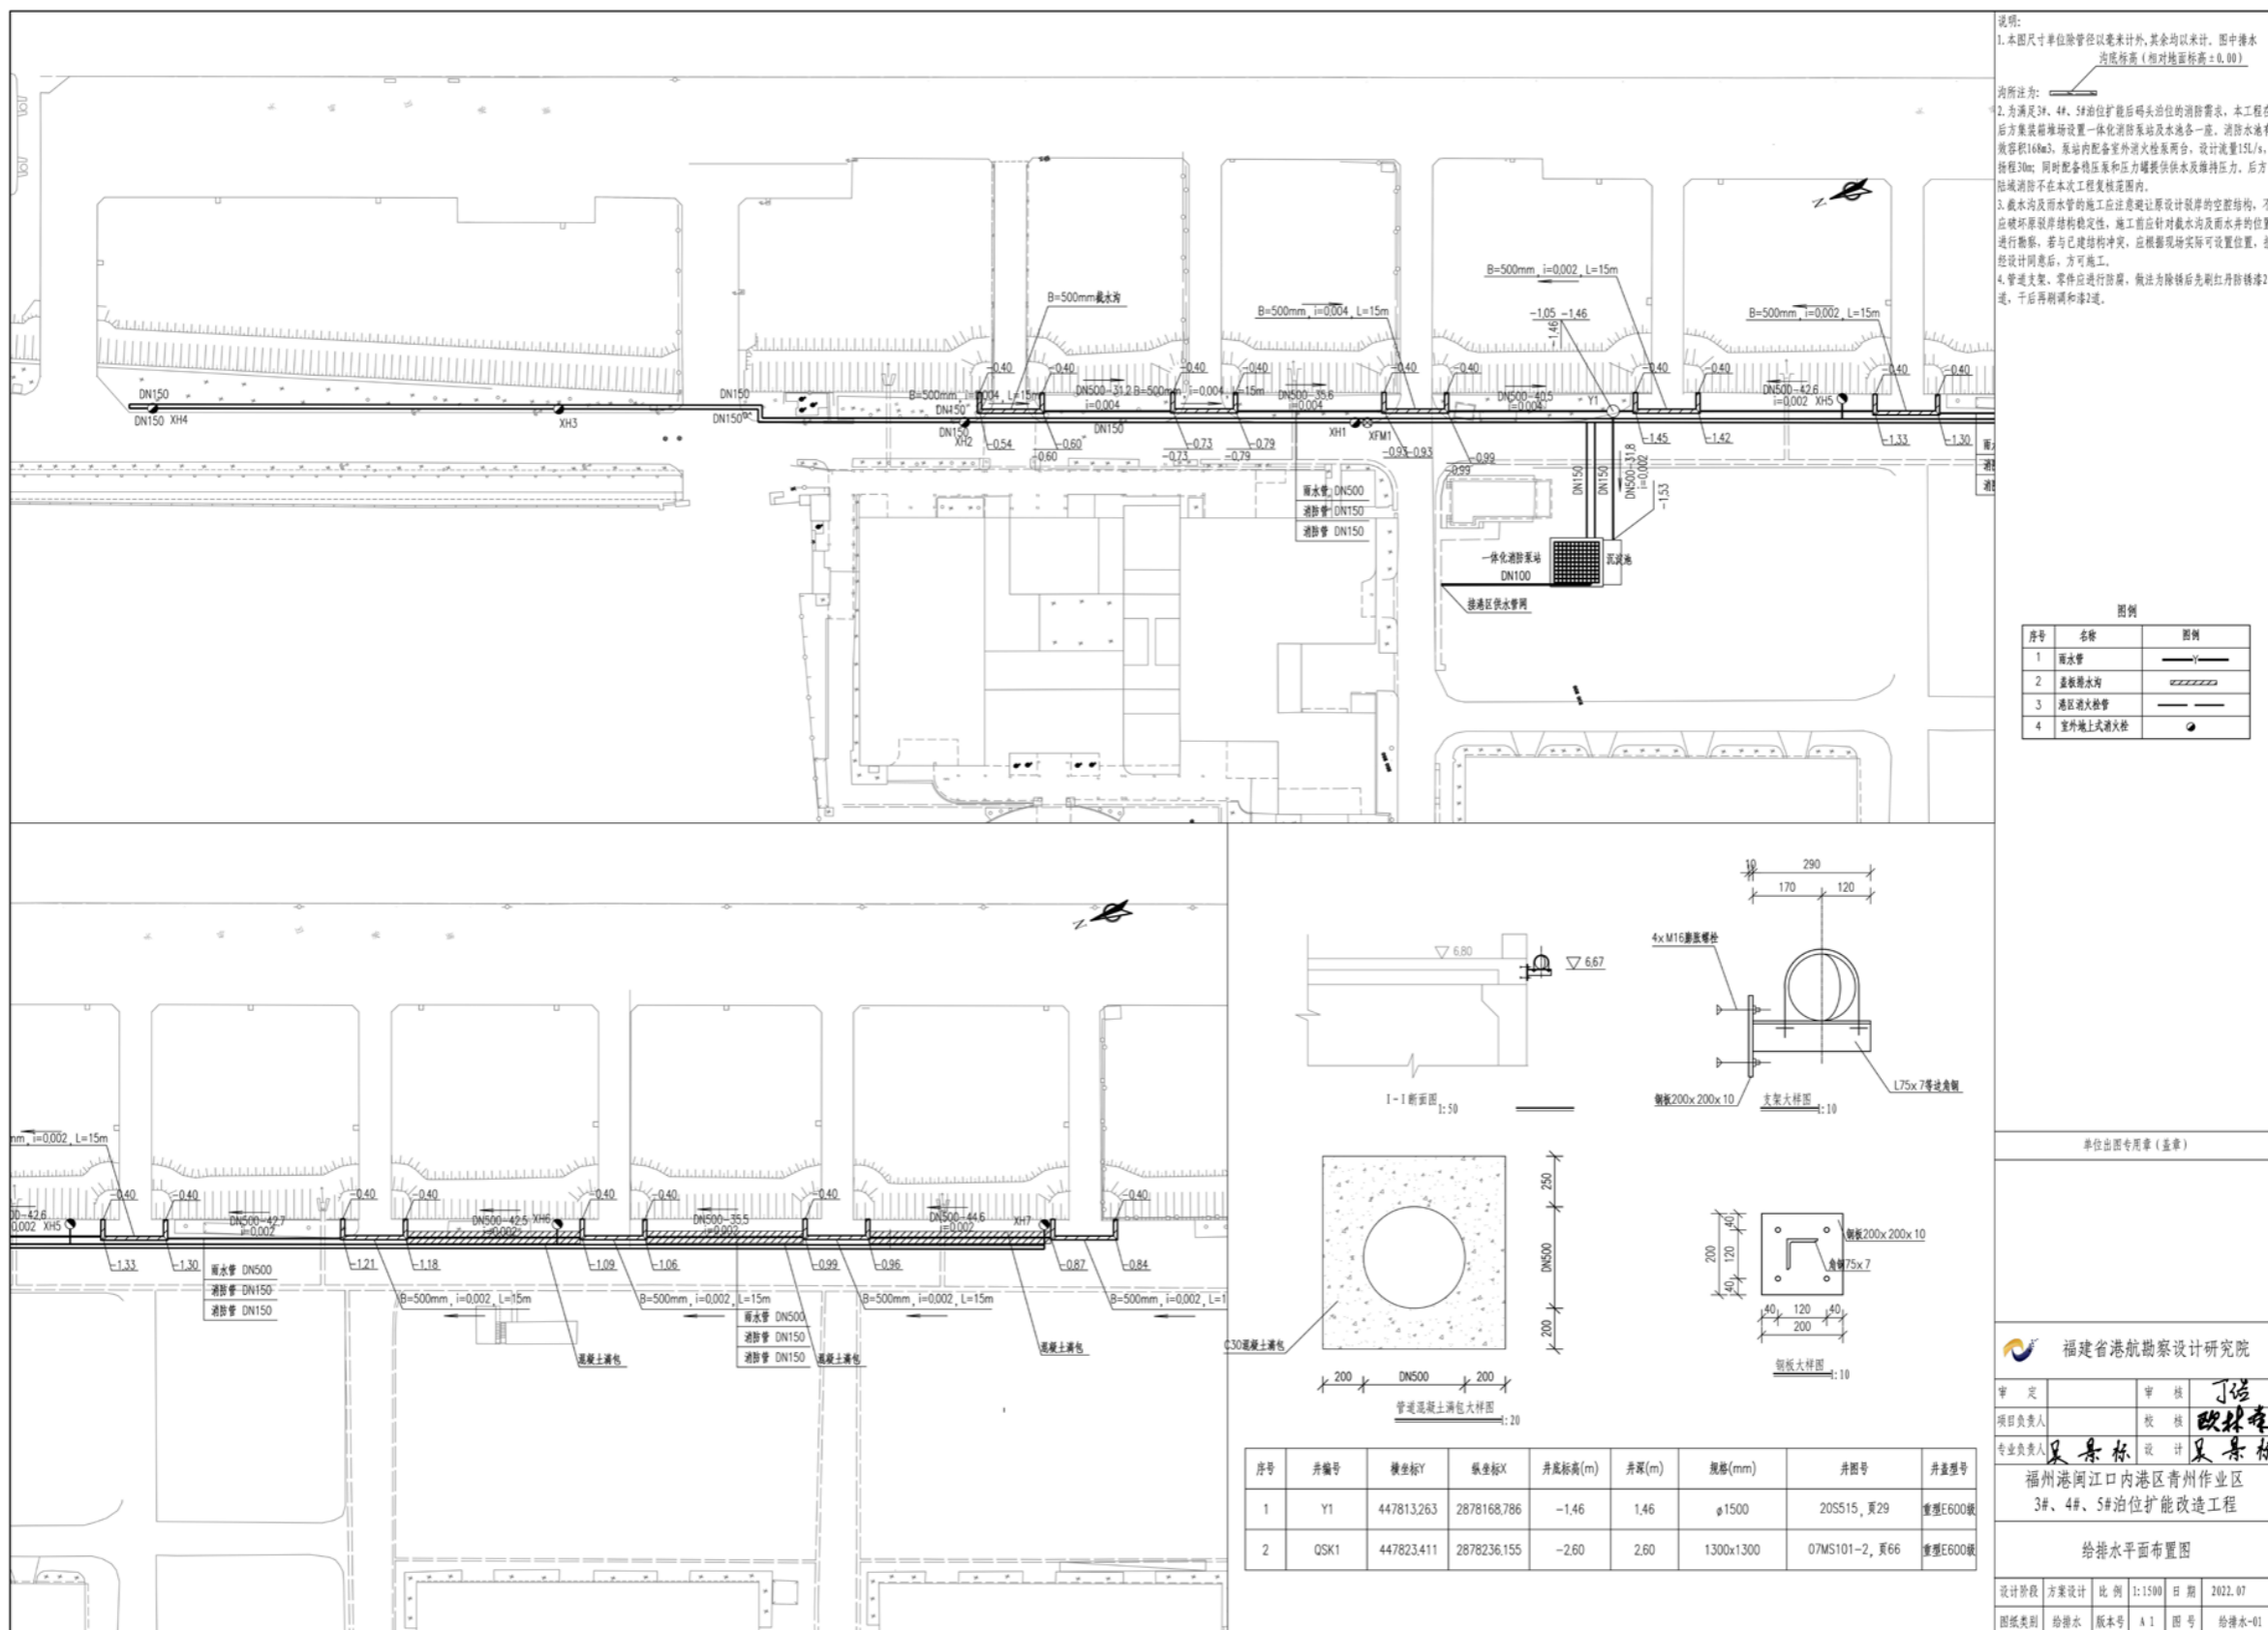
本项目扩能改造后给排水工程平面布置图
